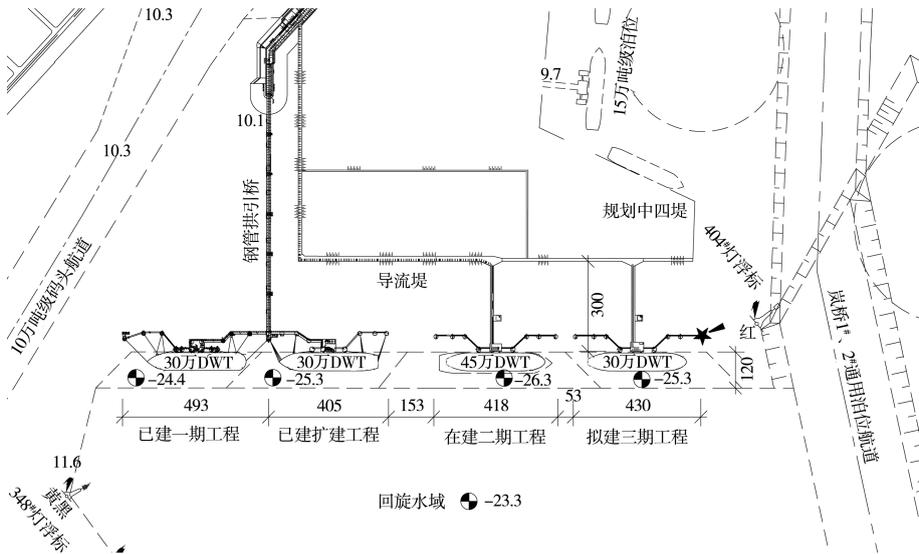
岚山港区 4 个 30 万吨级泊位平面布置 (单位: m)
